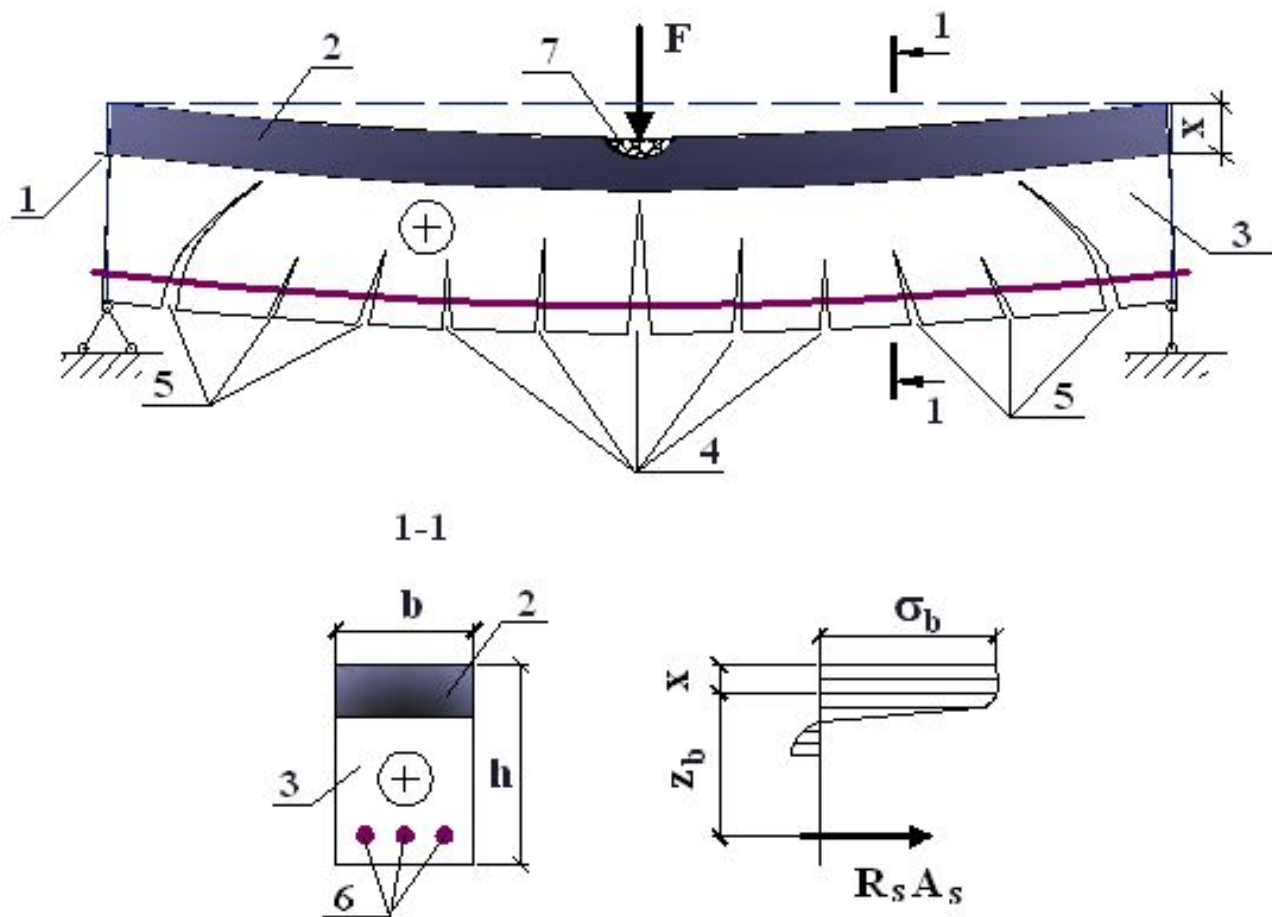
Схема разрушения железобетонной балки 1 – нейтральный слой (ось); 2 – сжатая зона балки; 3 – растянутая зона балки; 4 – трещины в нормальных сечениях; 5 – трещины в наклонных сечениях; 6 – стальная арматура; 7 – раздробление бетона сжатой зоны
